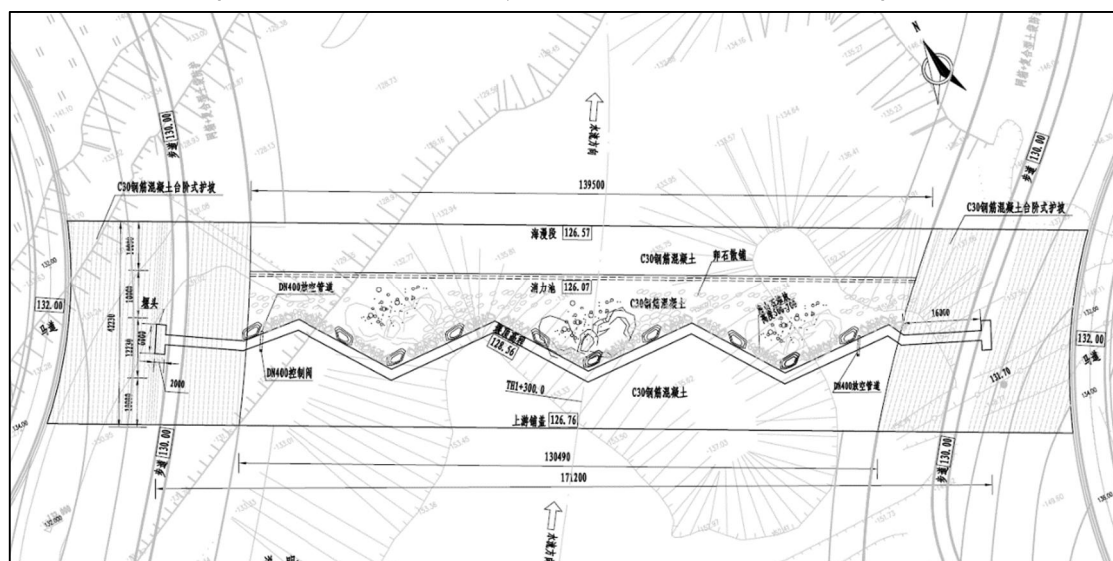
2#溢流堰（TX1+310）平面布置图
